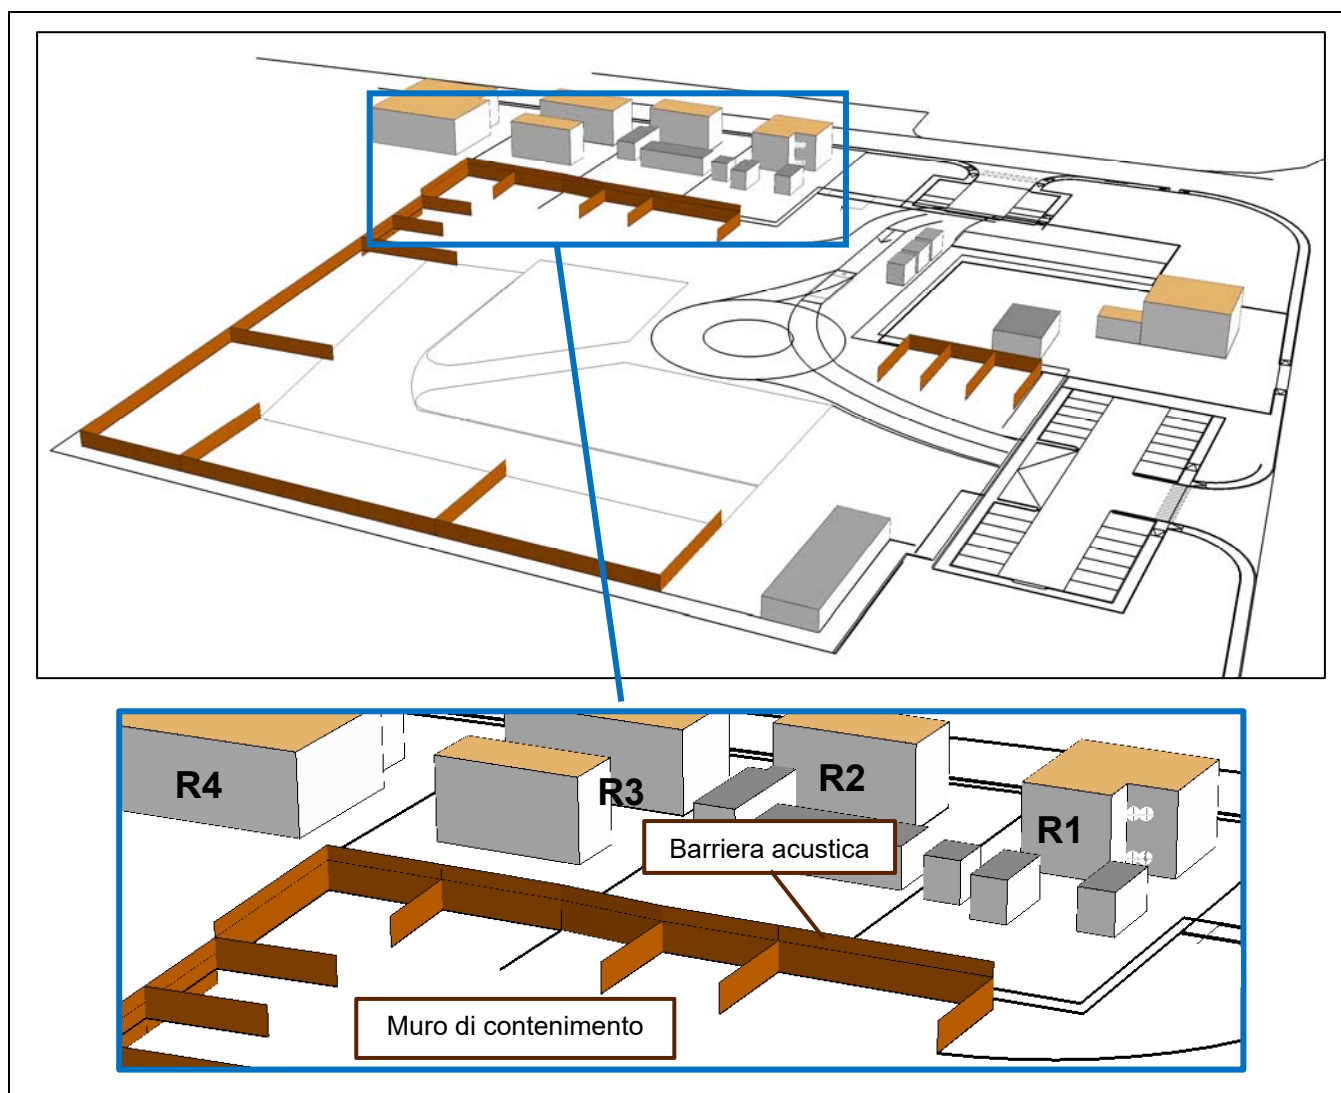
Muro di contenimento e barriera acustica – Scenario di progetto
